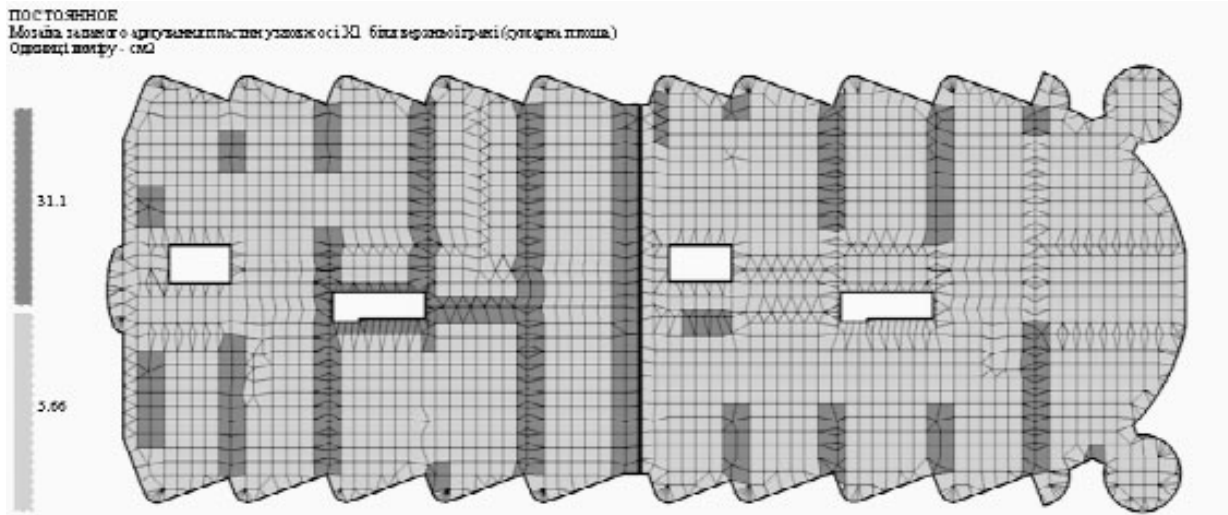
Схема армування монолітної плити перекриття в ПК "ЛІРА-САПР"
